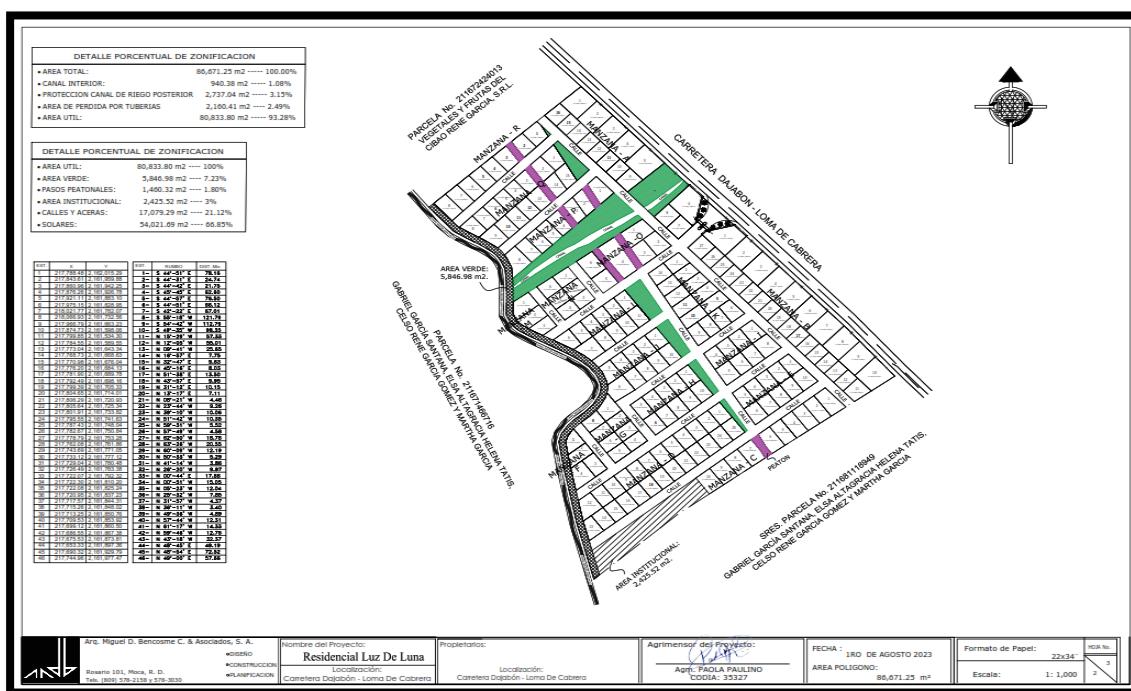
Vista del plano general del proyecto Lotificación Luz de Luna
